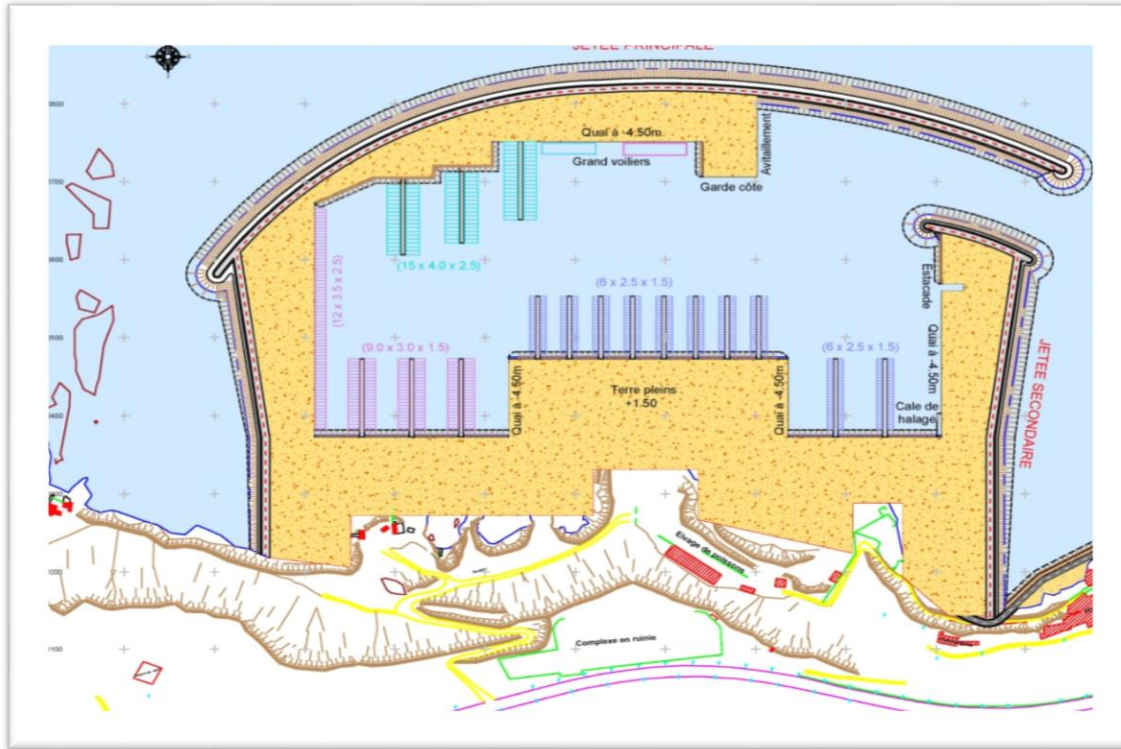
2 : Plan de masse de la variante 02 (LEM)
